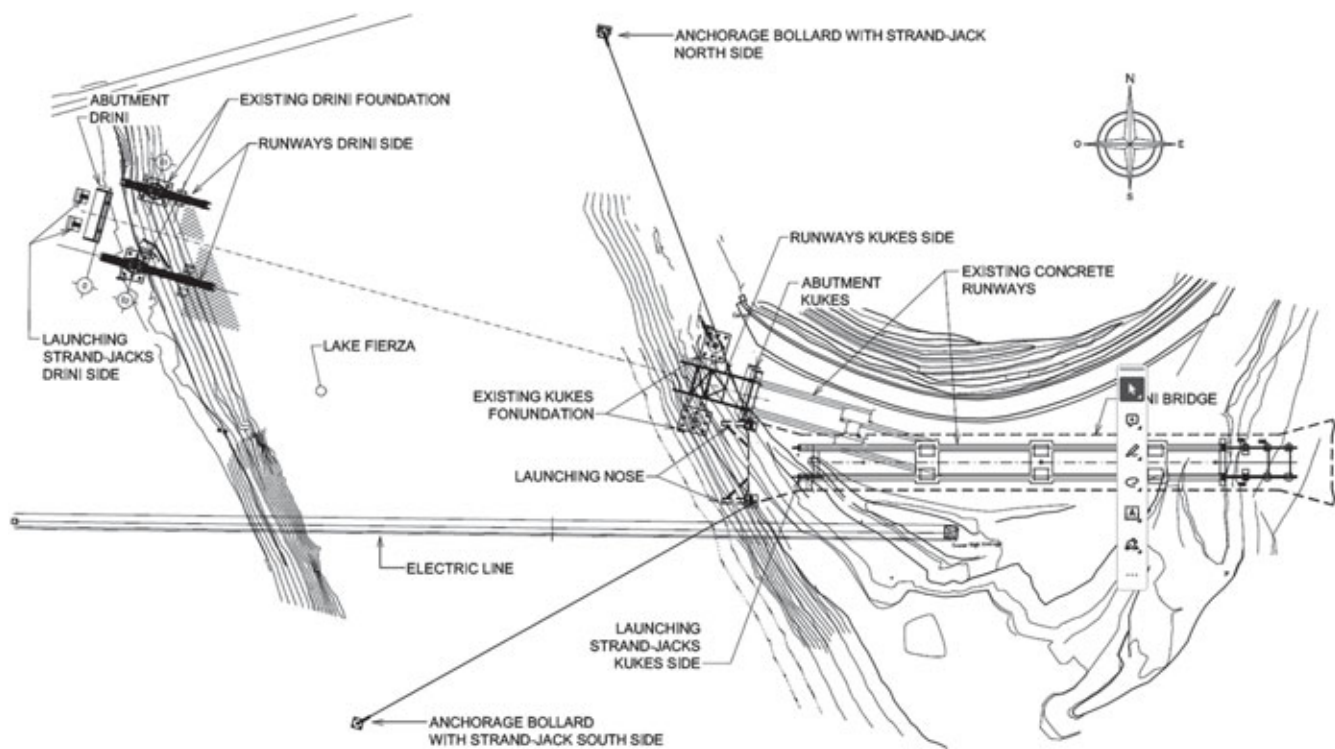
Layout delle strutture esistenti e integrative | Layout of existing and supplementary structures
